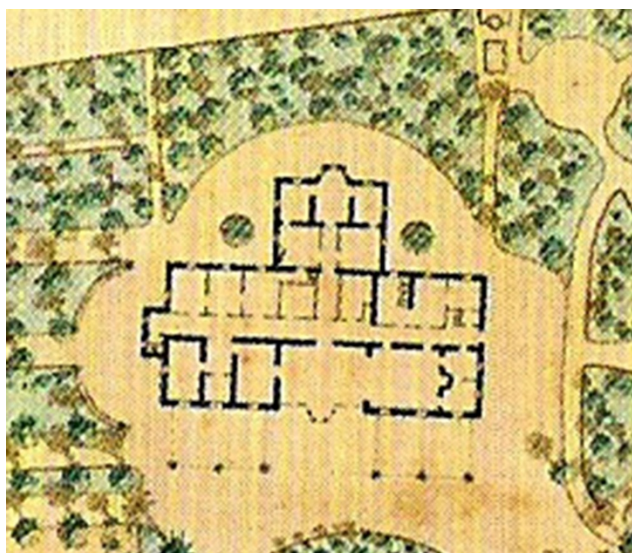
Detalle del plano de Miguel Palacios (1884) con la planta de la vivienda de El Altillo. Fuente: AFGB
